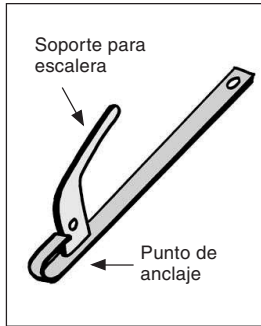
Detalle de un dispositivo de anclaje para cubiertas inclinadas
